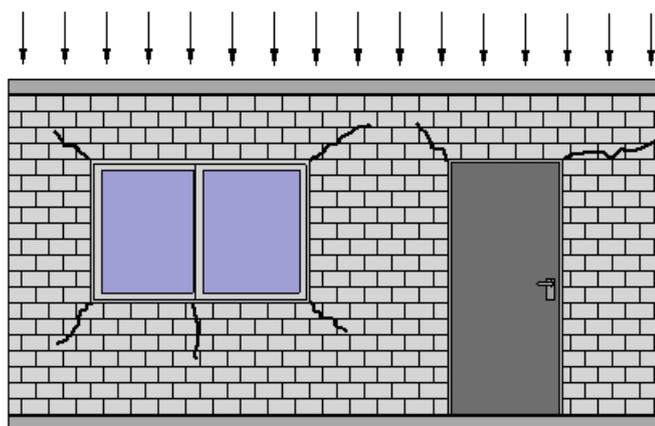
Fissuras verticais em paredes com cargas uniformemente distribuídas.
